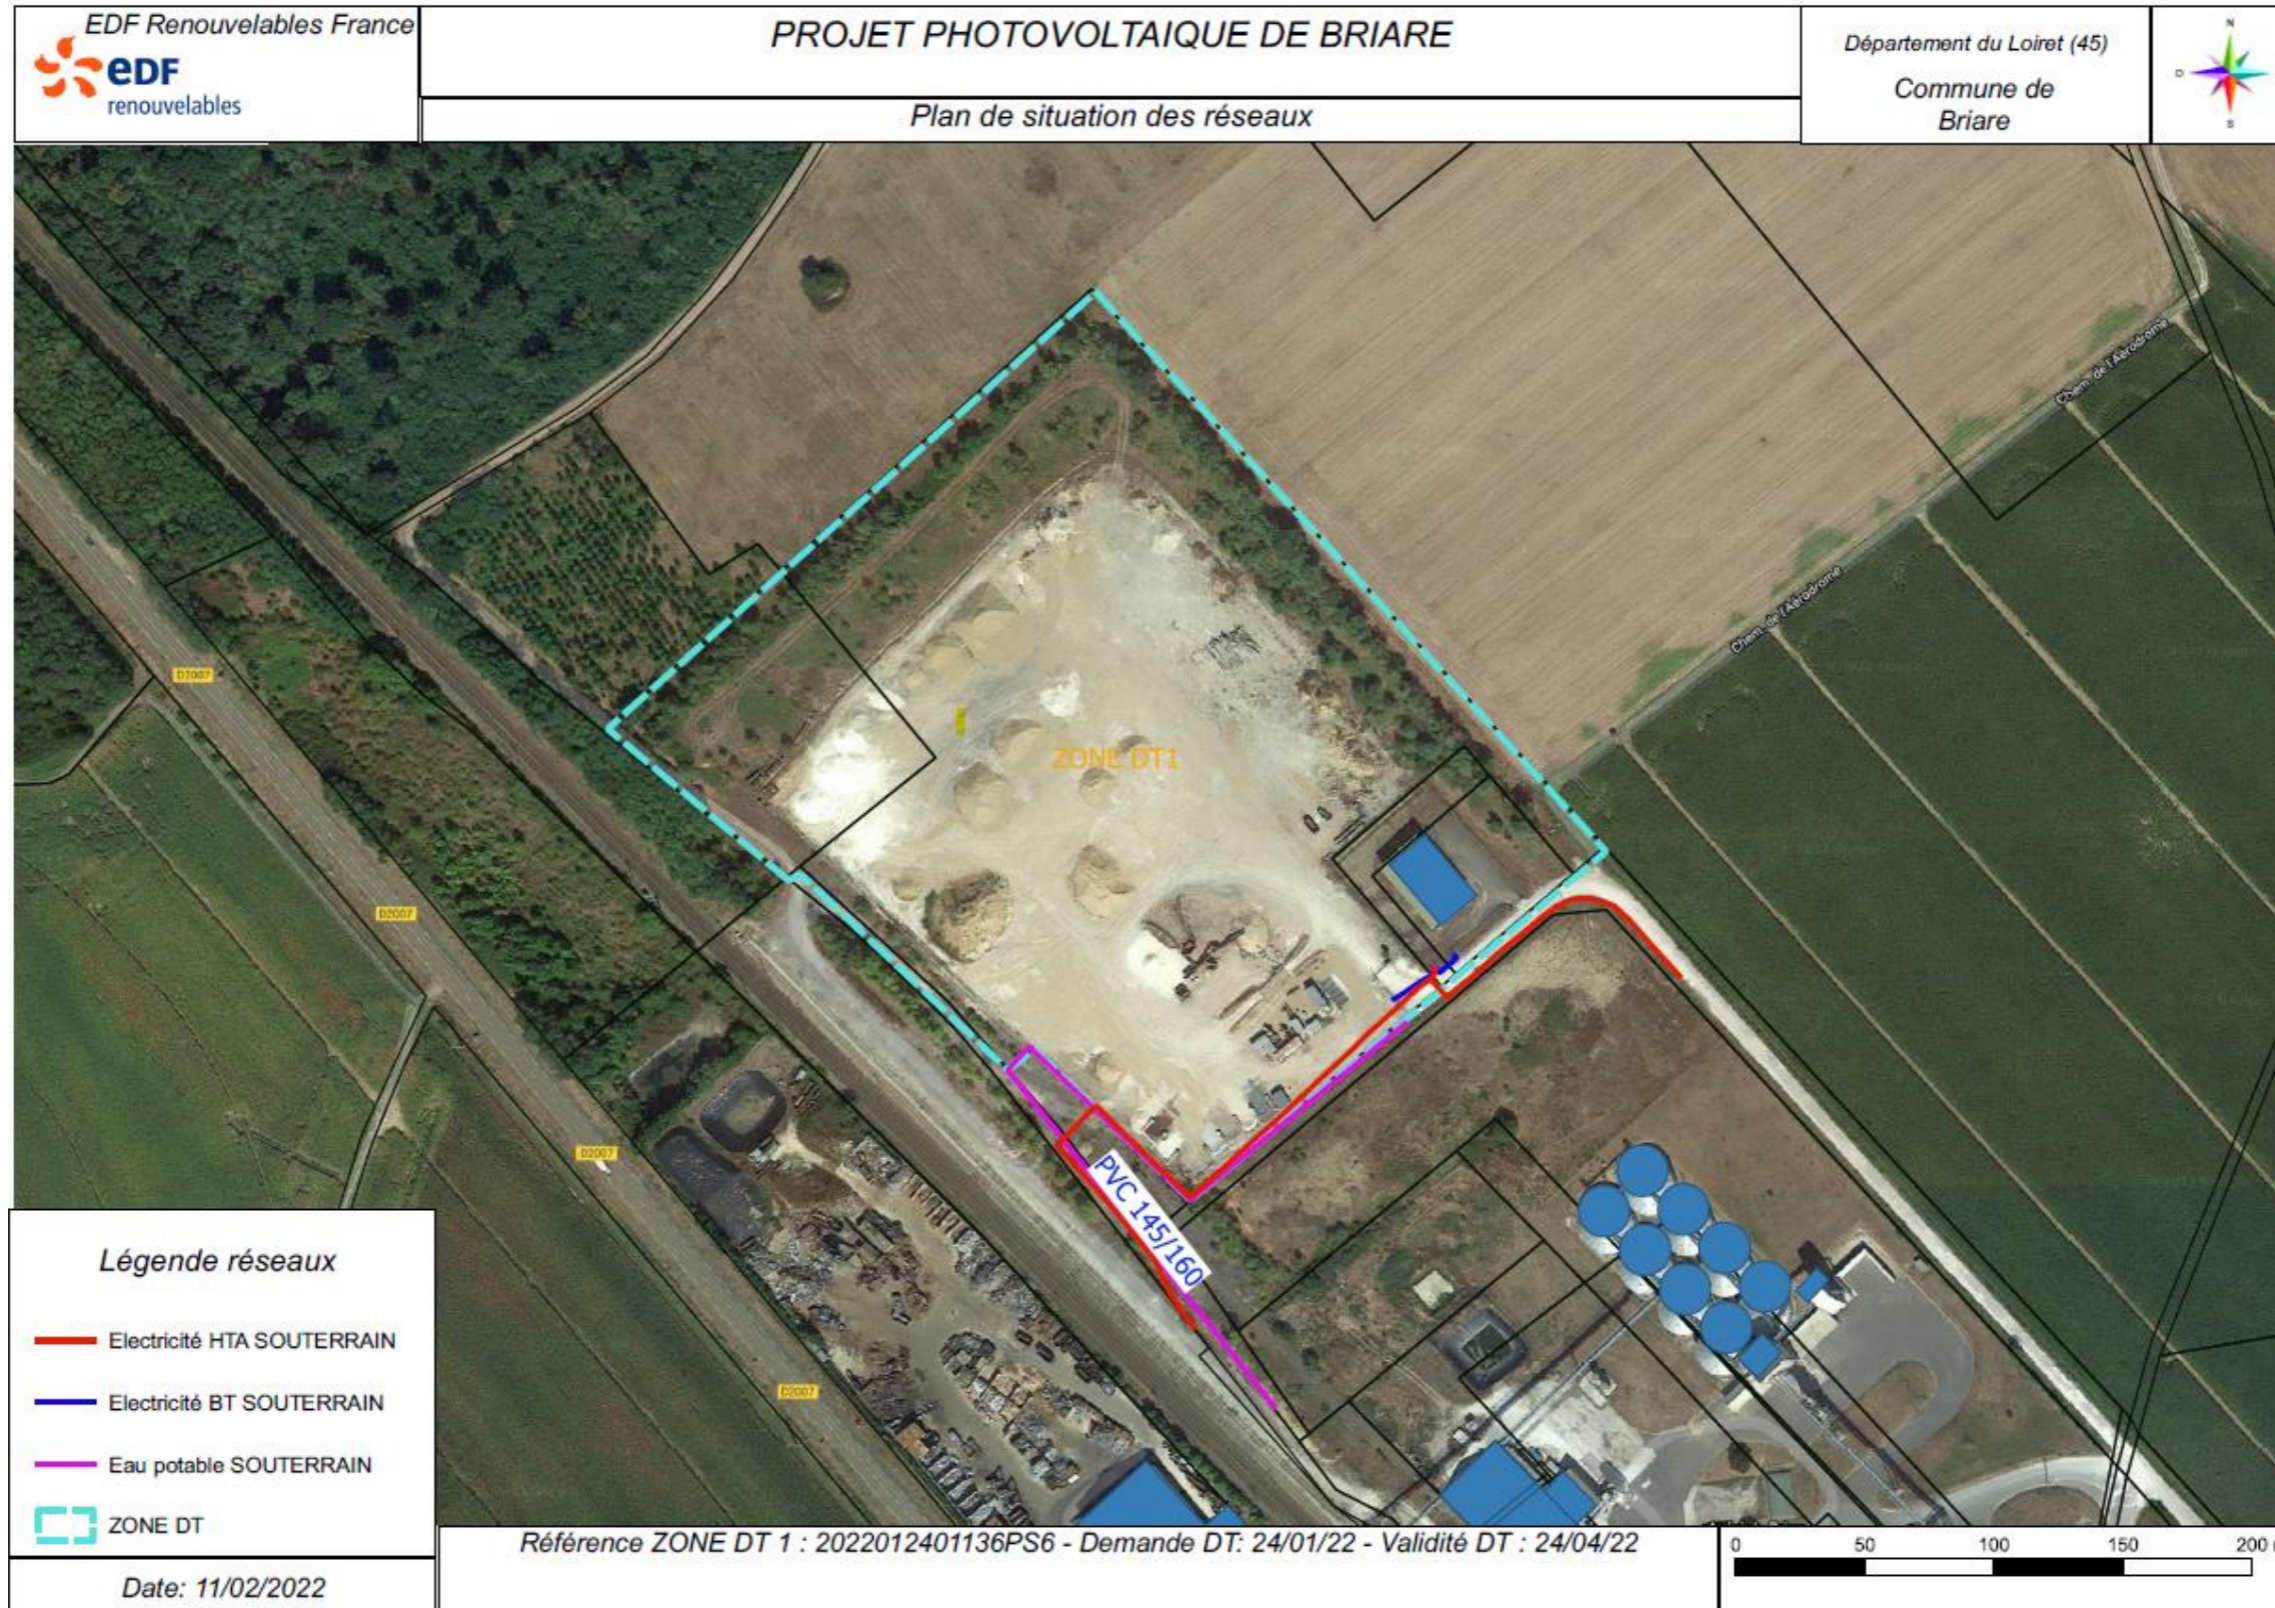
Plan de situation des réseaux (EDF Renouvelables France)
